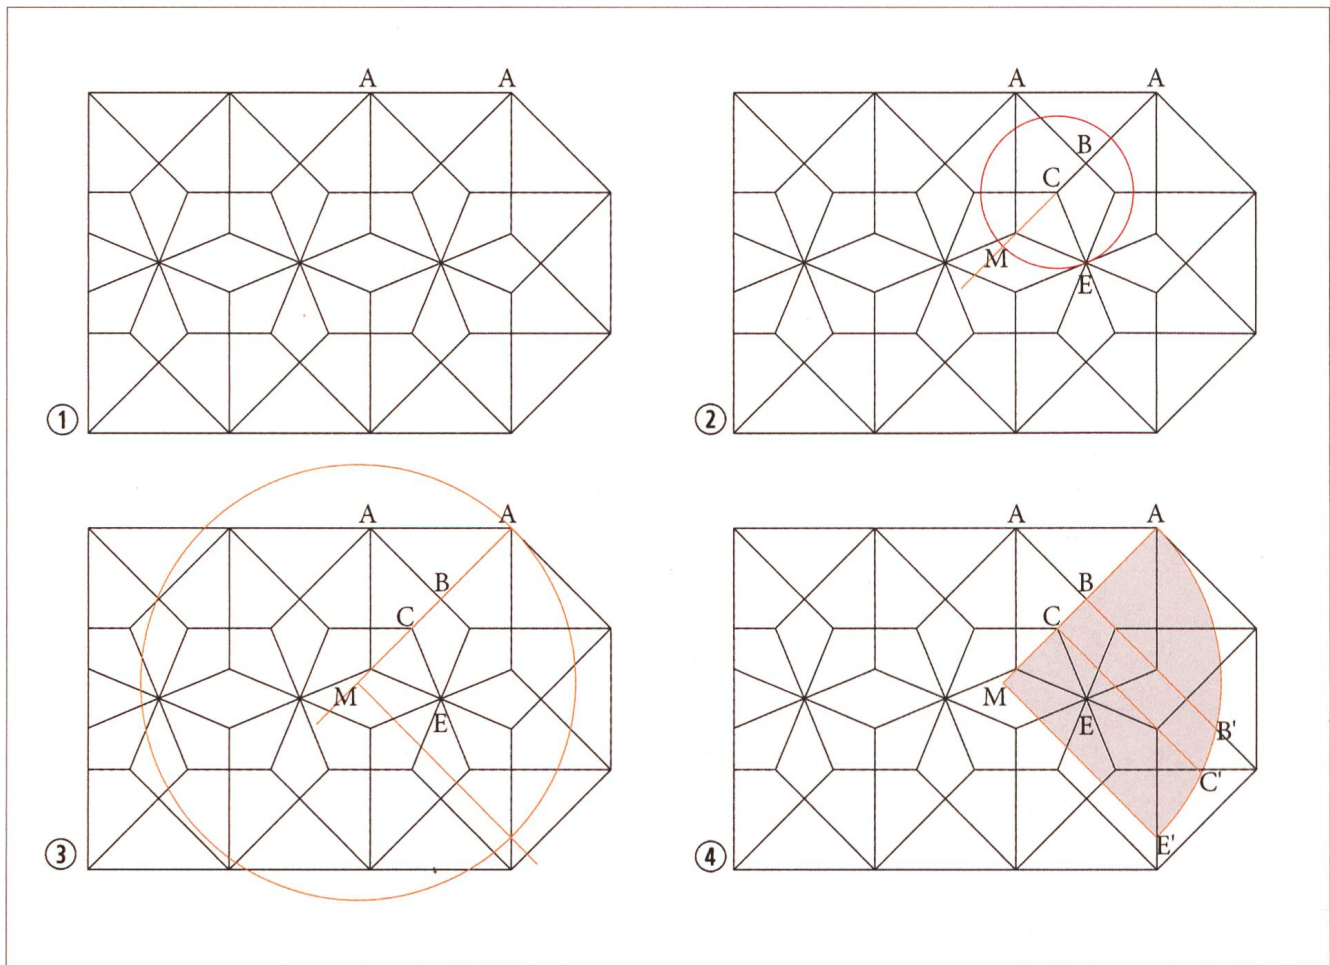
Planung der Bogenaustragung eines Haspelsterngewölbes aus dem Grundriss.
